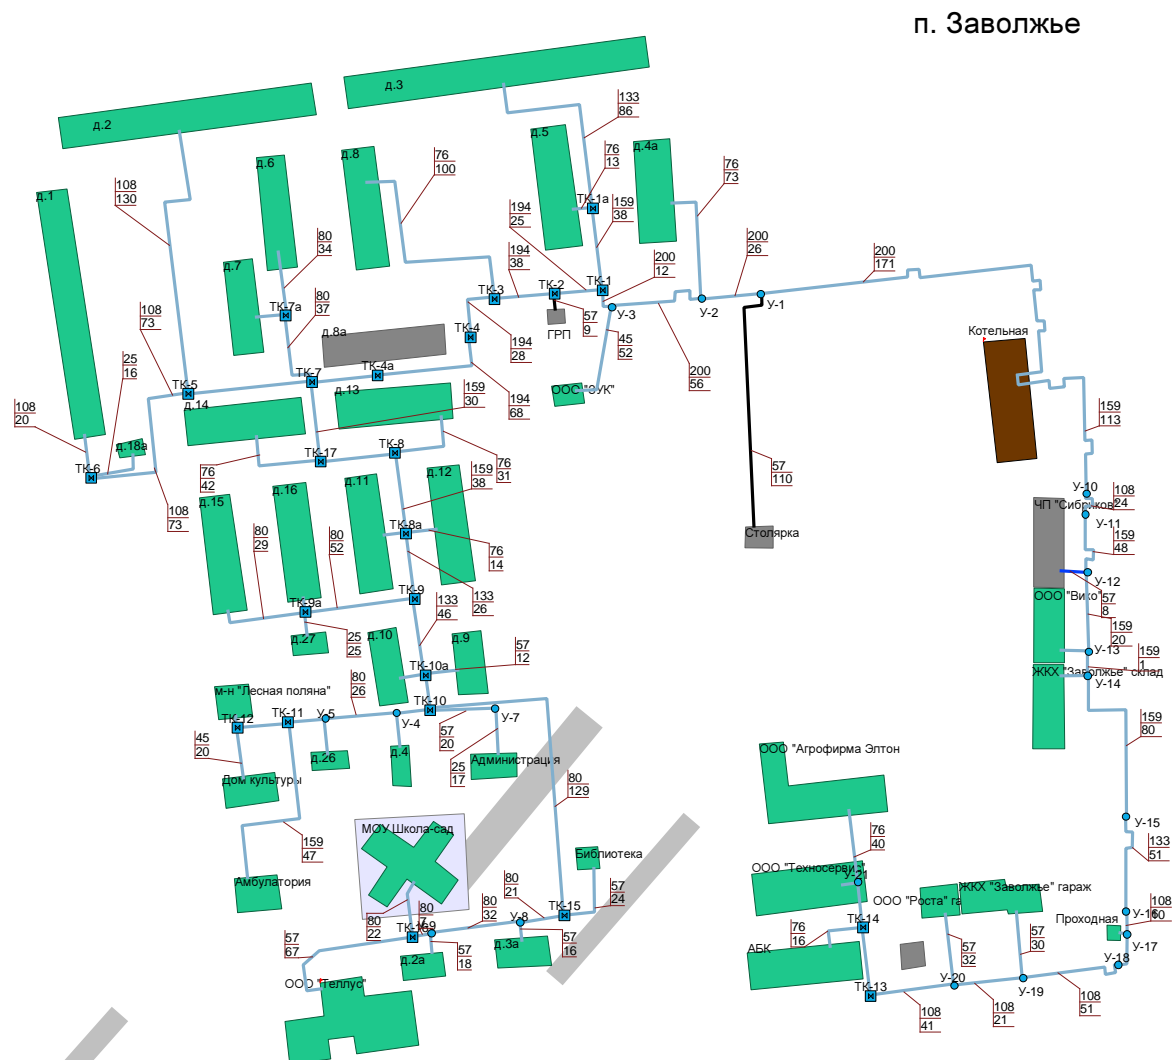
Наладка системы теплоснабжения – котельная п. Заволжье (сети отопления; с учетом перекладки тепловых сетей)
